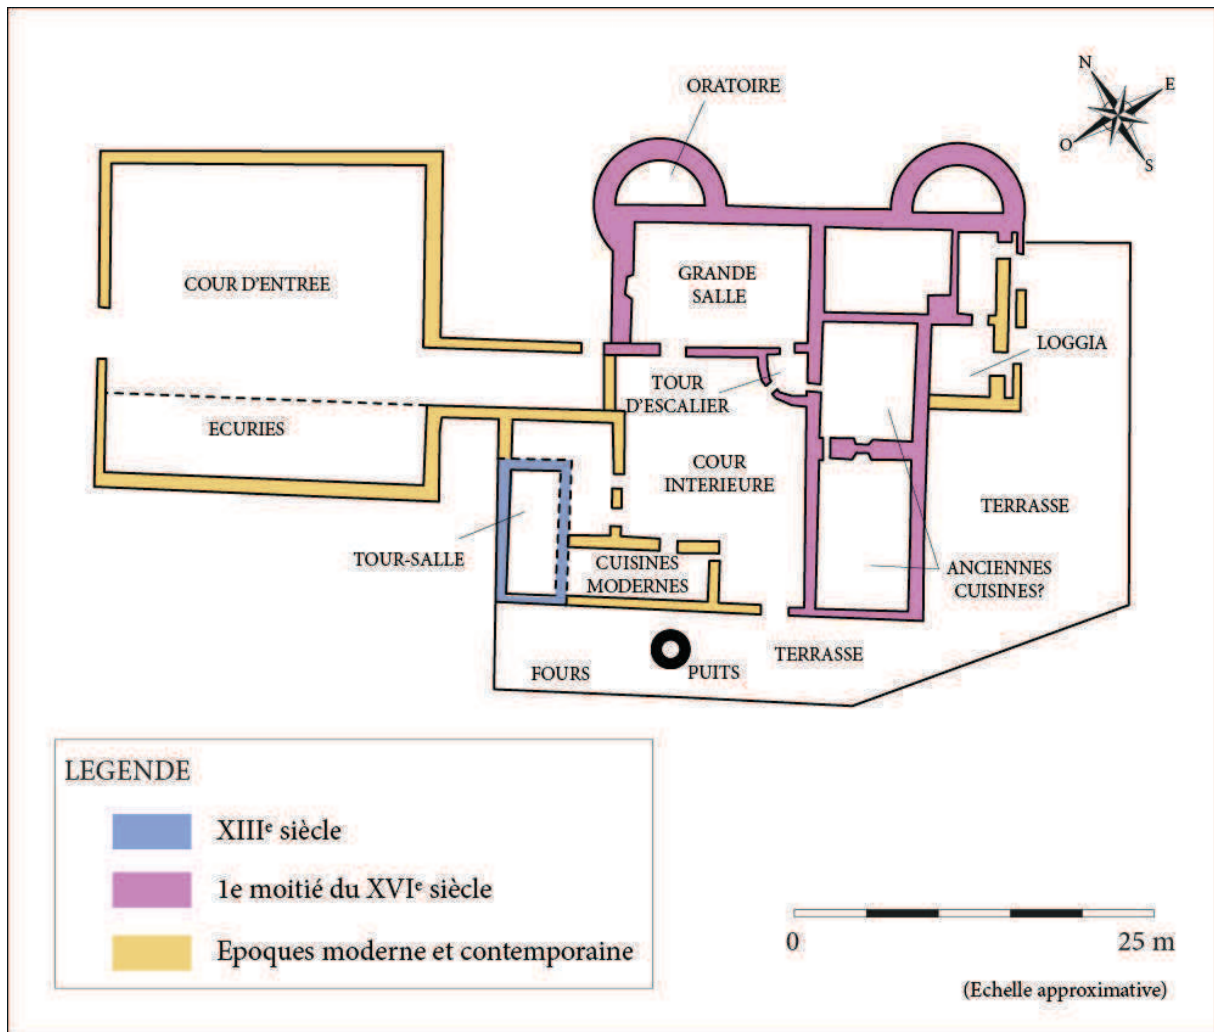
Plan schématique du château selon les plans de 1937. DAO : F. Boisserie.
